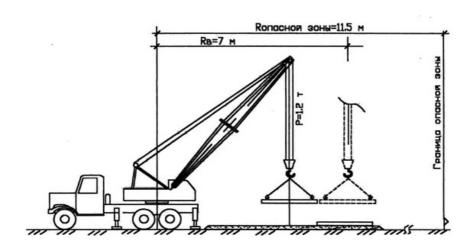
Схема укладки ж.б. плит ПДН-14 на рабочей площадке
